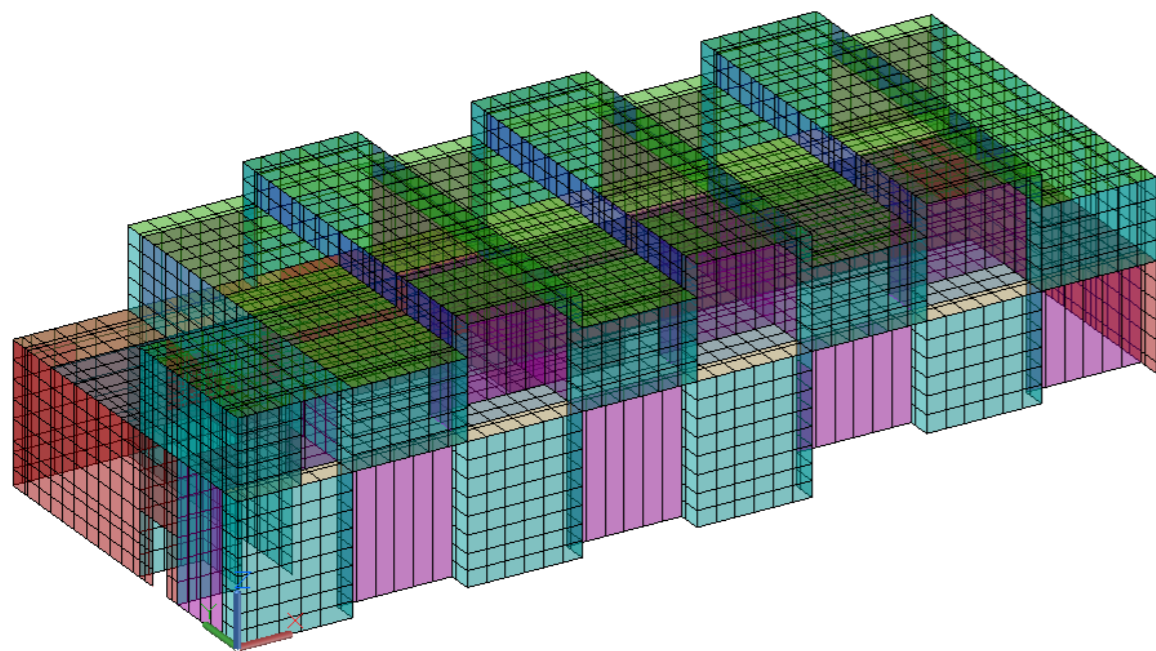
Modelo de cálculo en AutoCAD. Fuente: elaboración propia
